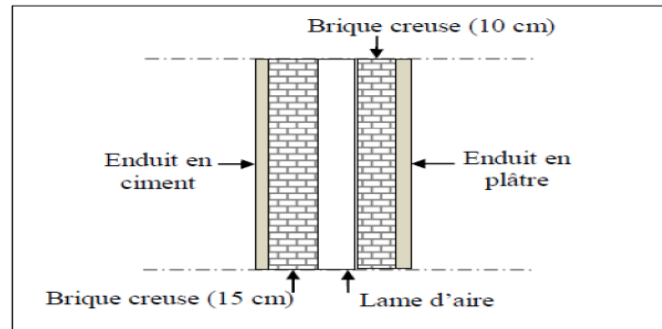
Coupe transversale du Mur extérieur (double paroi).[1]
